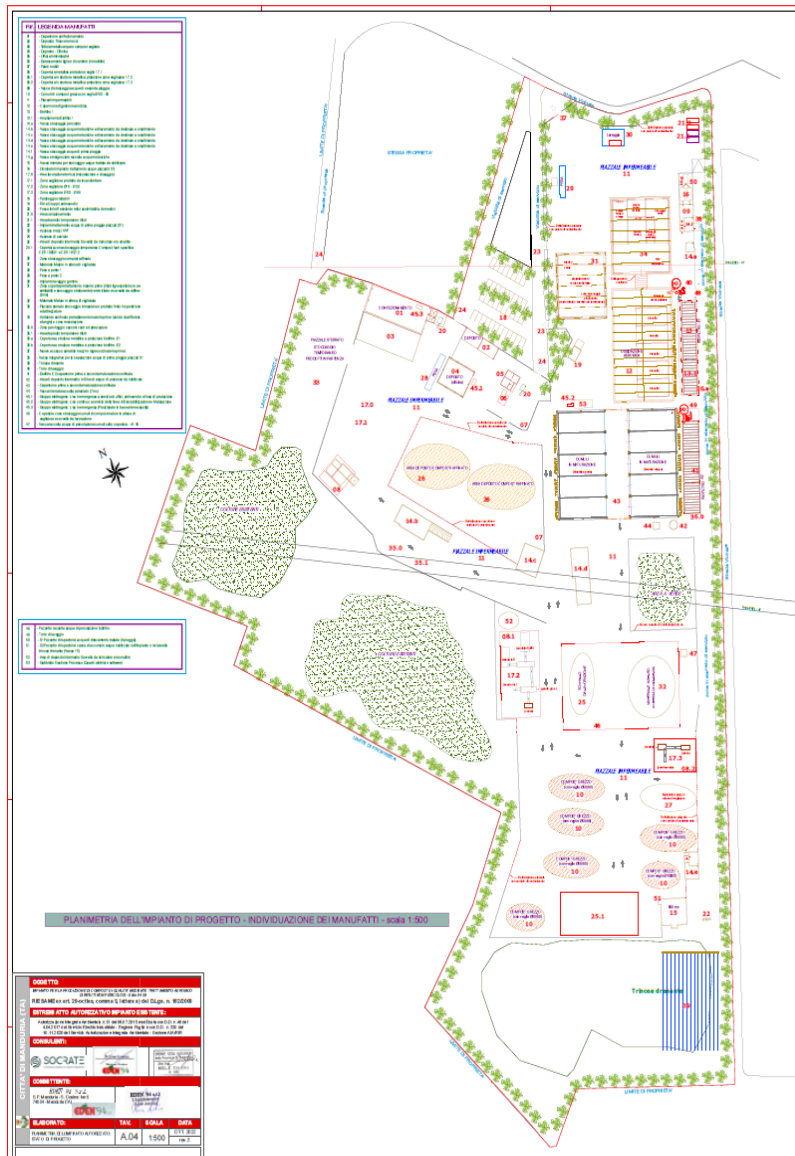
TAV. A.04 REV.03 - Planimetria dell’impianto – stato di progetto
